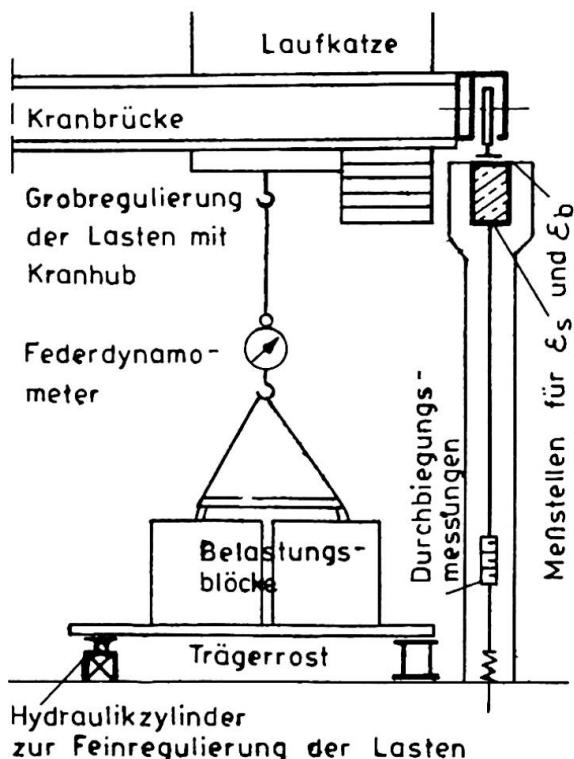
Prüfung eines Stahlbeton-Kranbahnenträgers
